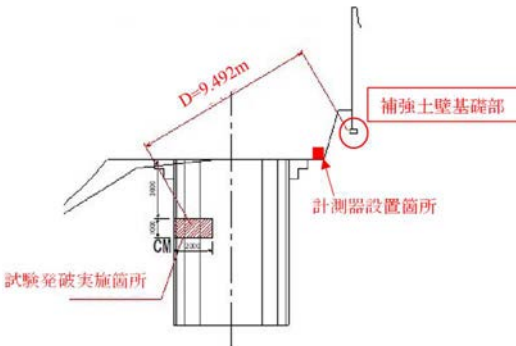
大須ヶ洞第三橋の横断面図 (P3 橋脚を代表)
